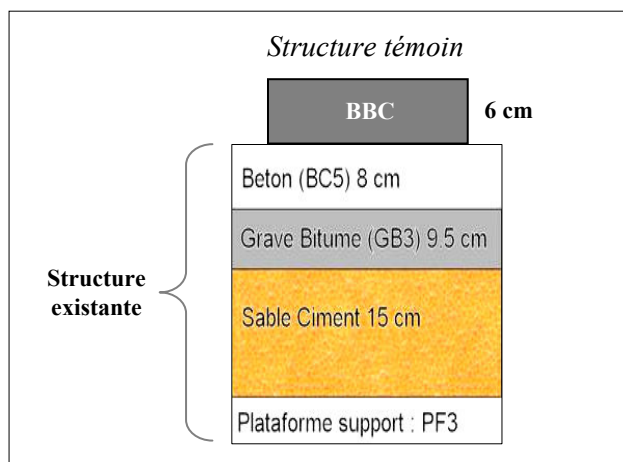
Structure modélisée de la piste d'essai FABAC correspondant à la structure témoin.
